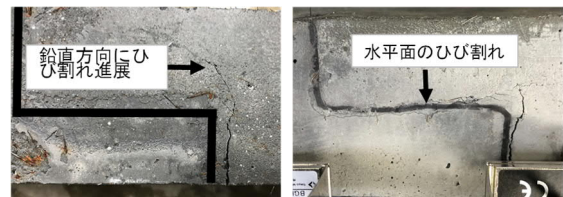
かぎ型継ぎ手のひび割れ状況
